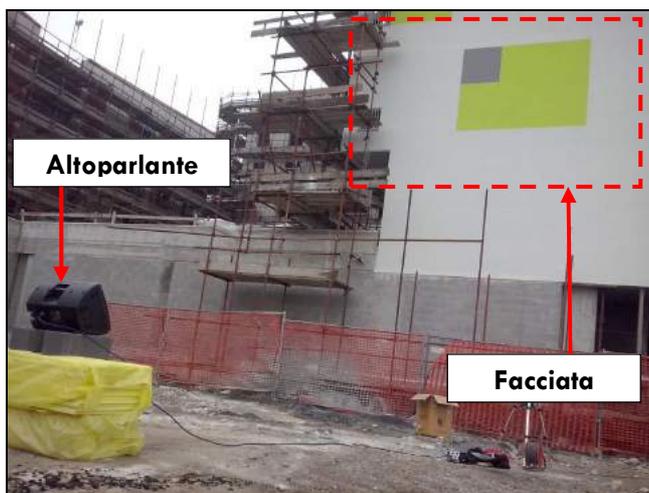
Posizione dell'altoparlante rispetto alla facciata
